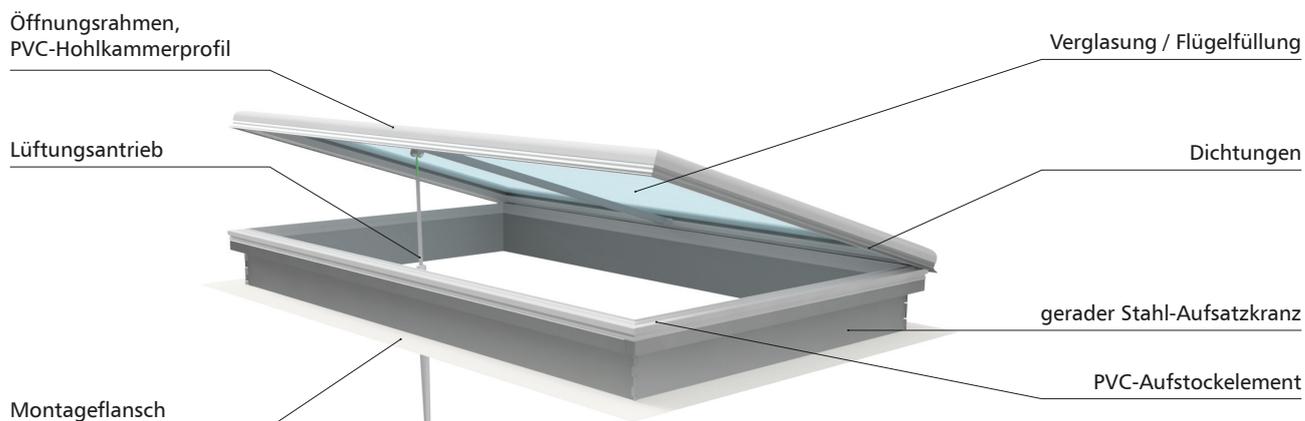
Aufbau einer Lüftungsklappe mcr ULTRA THERM Typ E mit elektrischem Lüftungsantrieb
